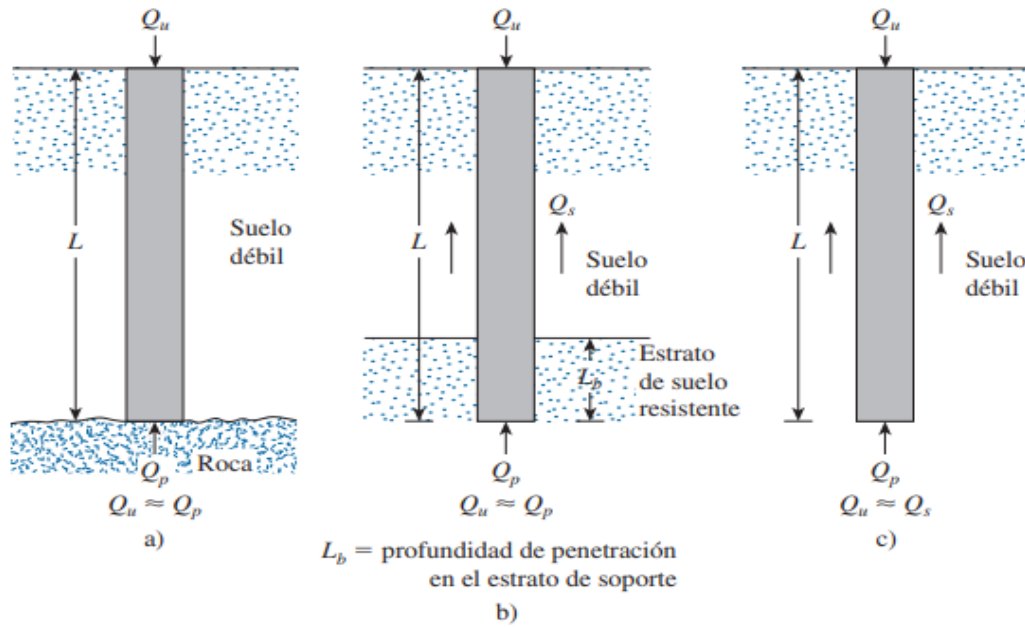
Pilotes de carga de punta y pilotes de fricción.
